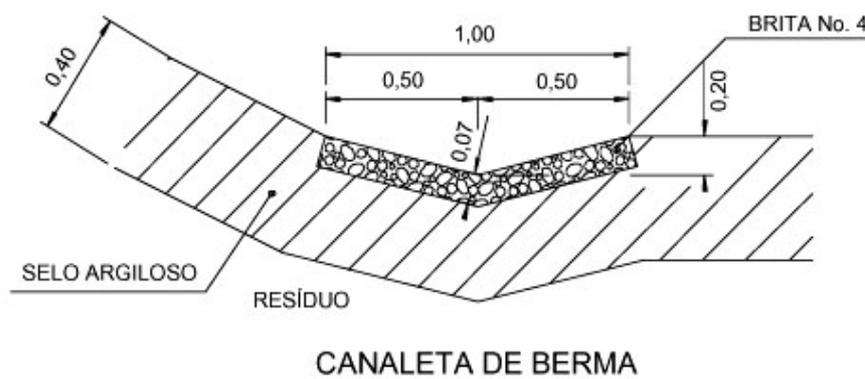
Detalhe da canaleta de berma.
